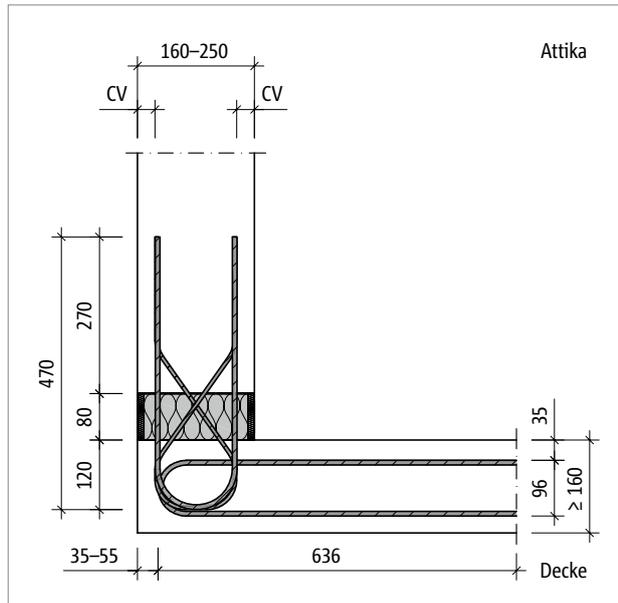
Schöck Isokorb® T Typ A-MM1-X80: Produktschnitt
